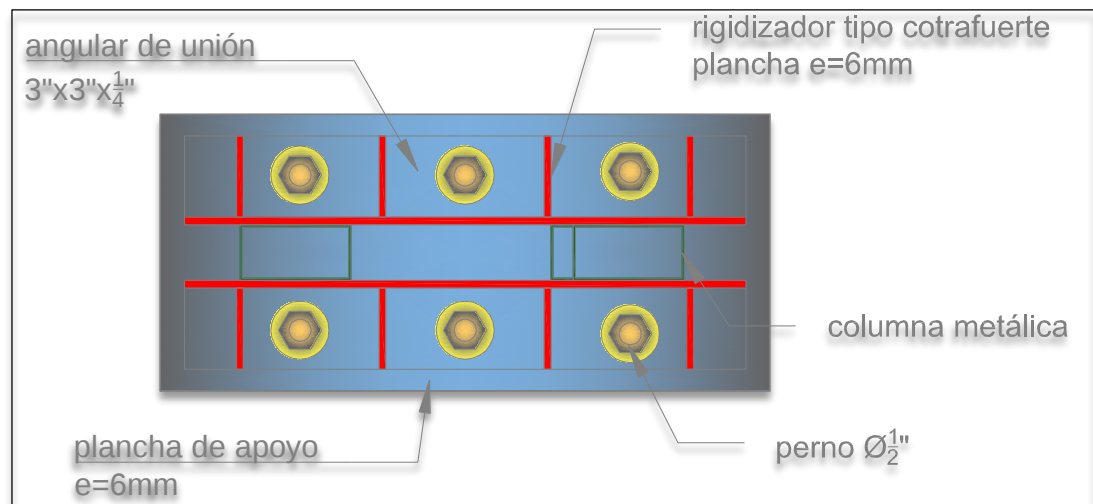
Detalle de Placa Base, Elaboracion Propia
